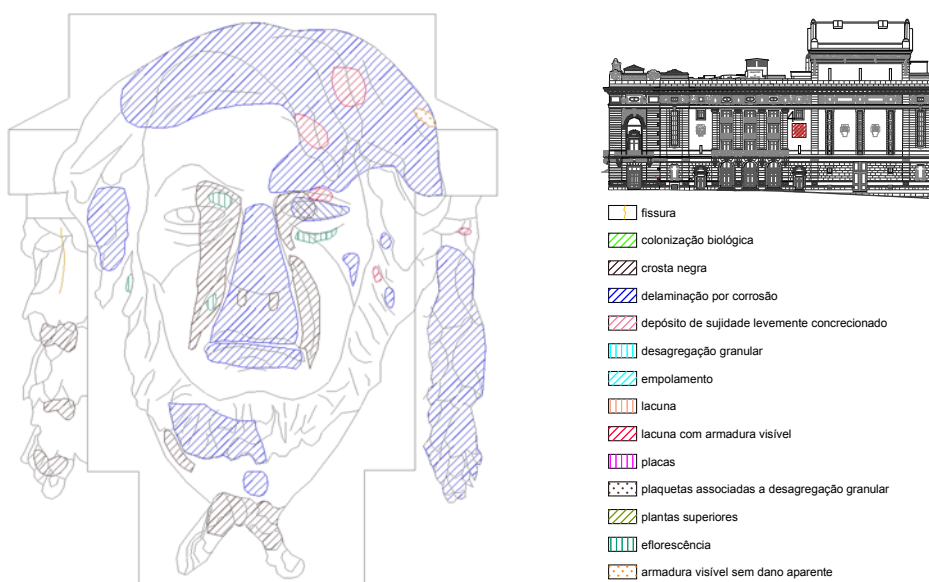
Levantamento de danos em elemento escultórico após a primeira limpeza geral das fachadas e a aplicação de biocida executado pela empresa CaCO3.
